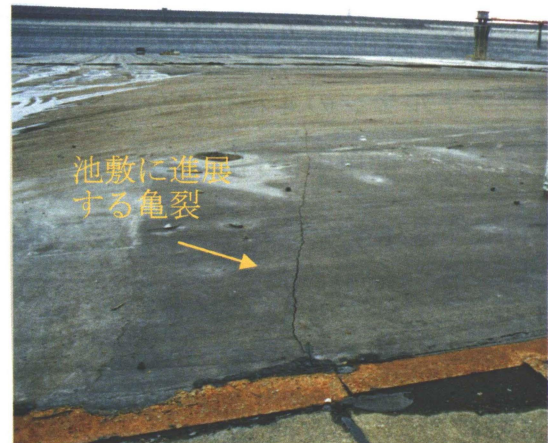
コンクリートライニングの打継目により生じた亀裂(A-32)
